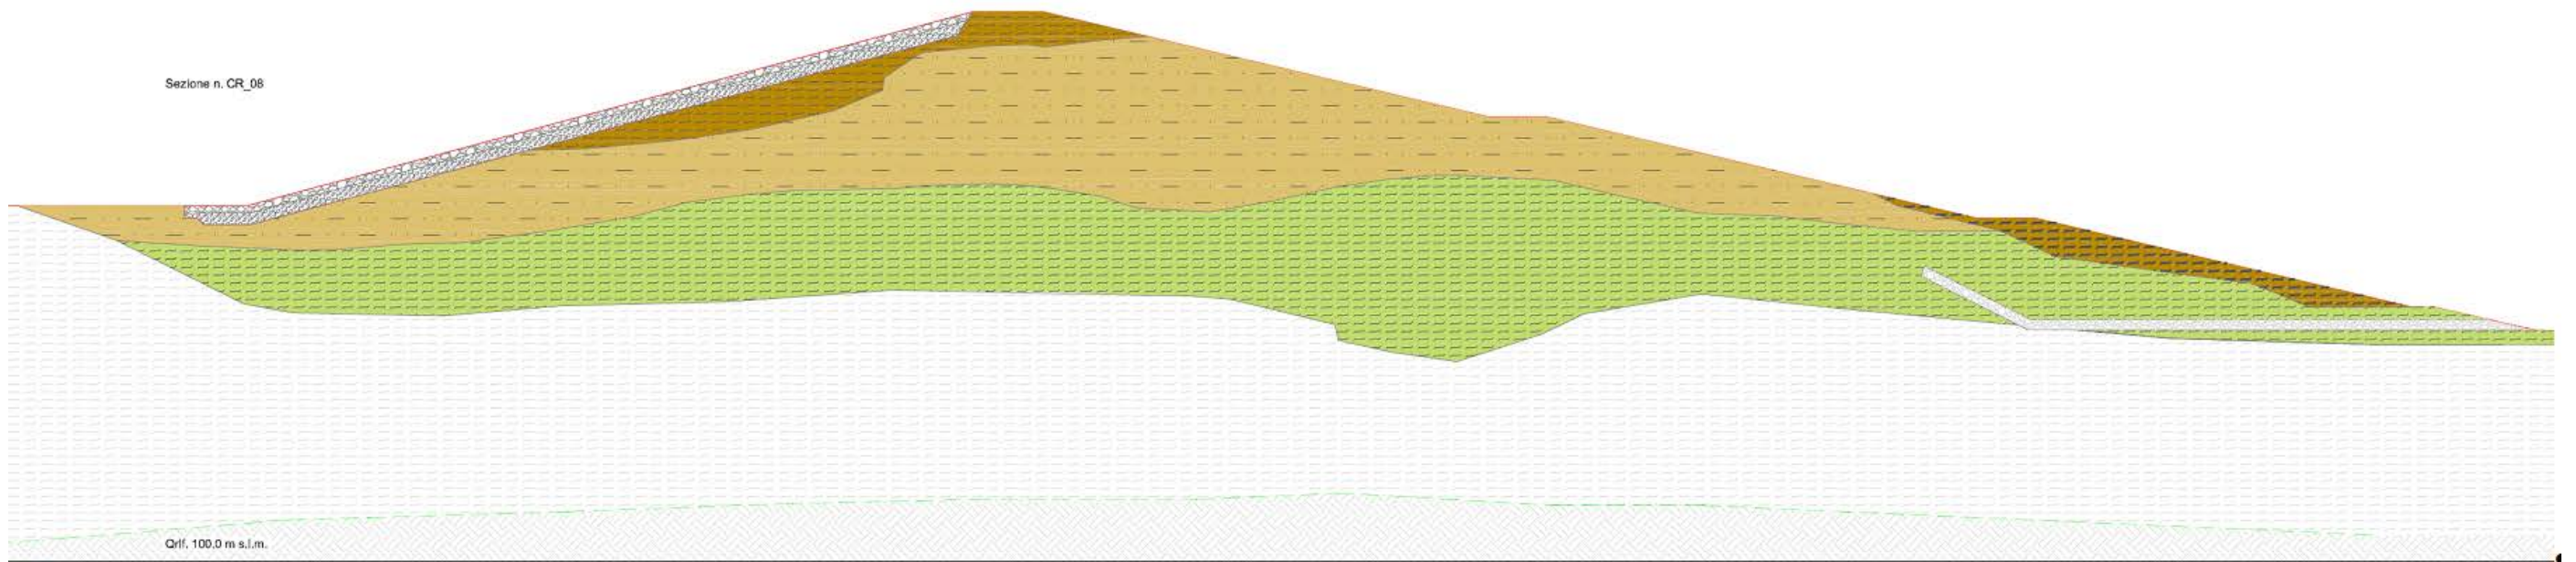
Stratigrafia sezione principale del corpo diga (sezione CR_08).
